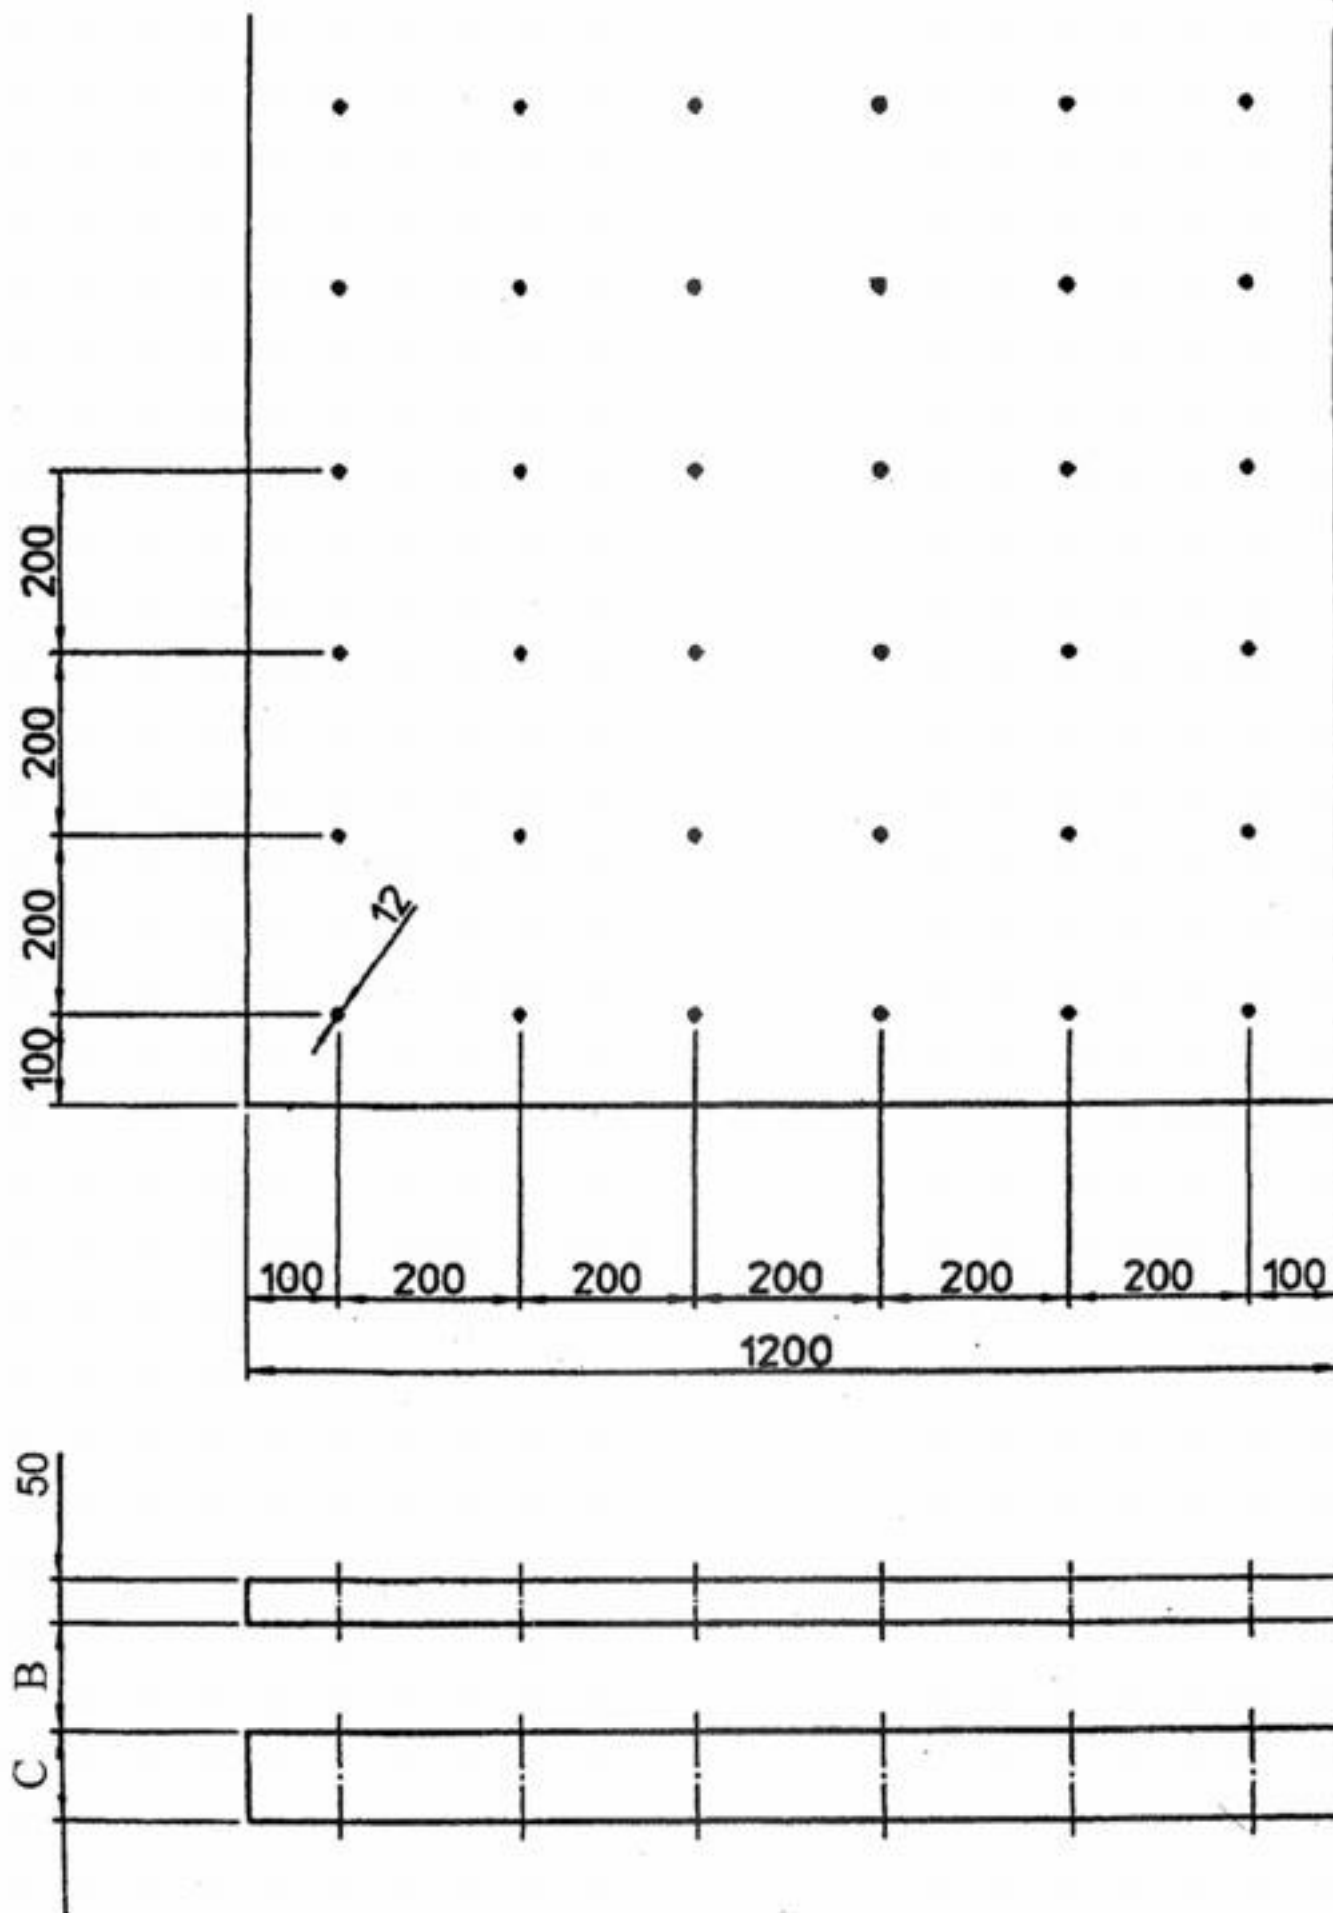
Рядовой элемент опалубочный наружной стены
